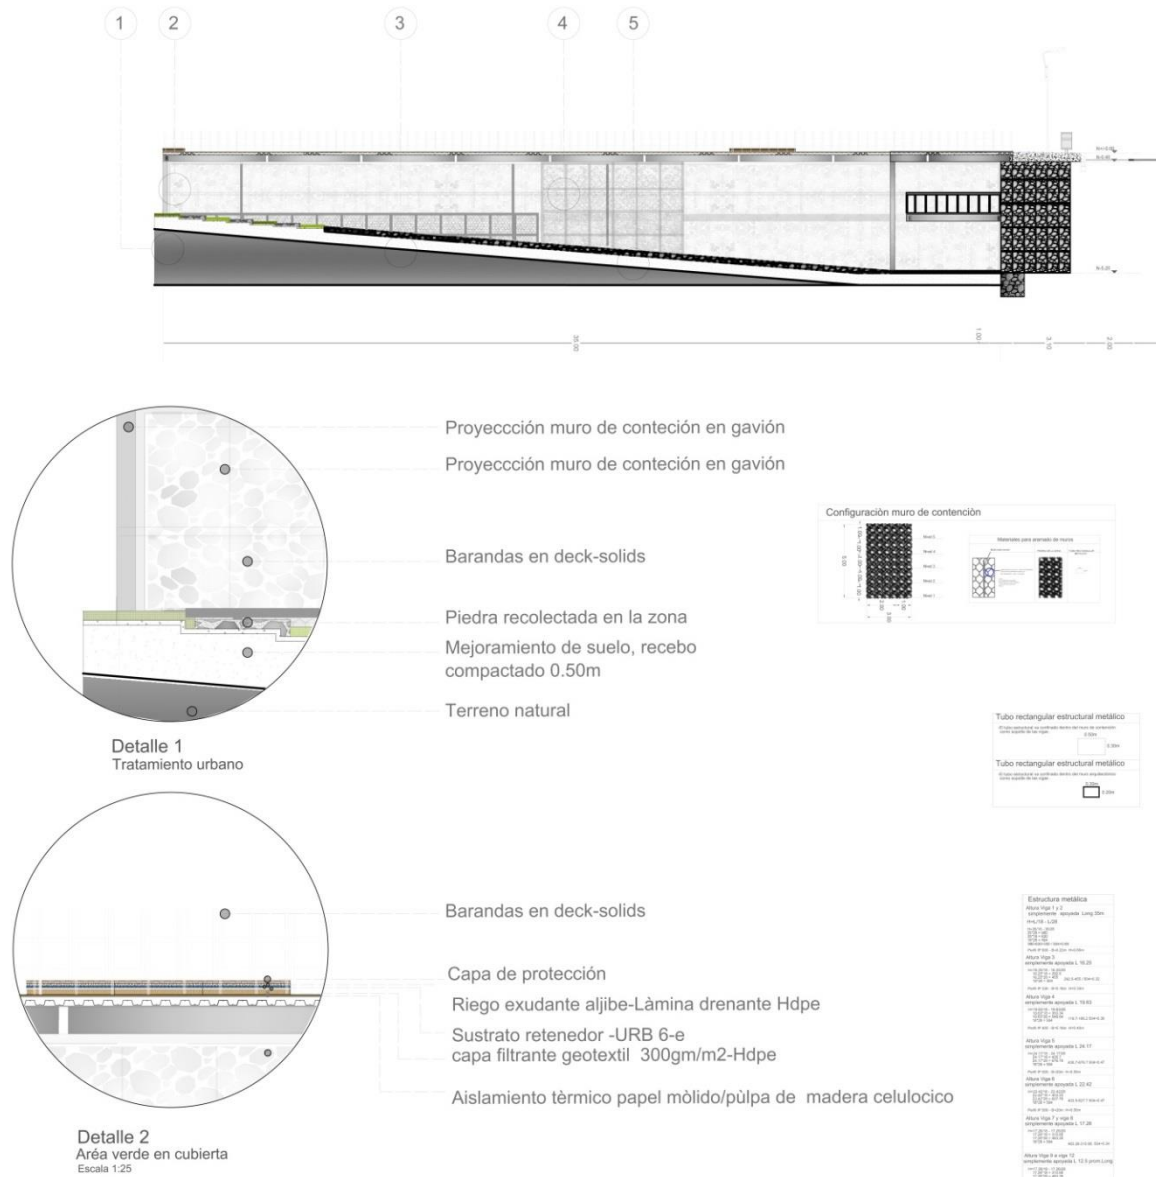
Corte constructivo, equipamiento pedagógico. Fuente: Paola Caballero
